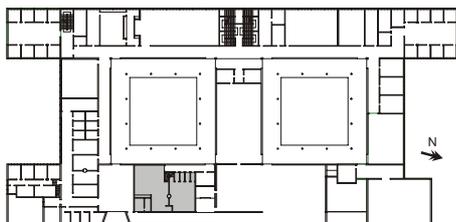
Localização das áreas de sacristia, segunda versão de projeto. Primeiro Pavimento. (Desenho da autora).
